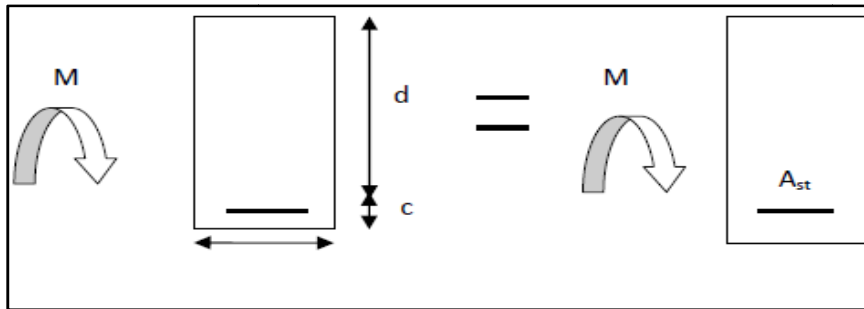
Schéma de Ferraillage des poutres simplement armée
